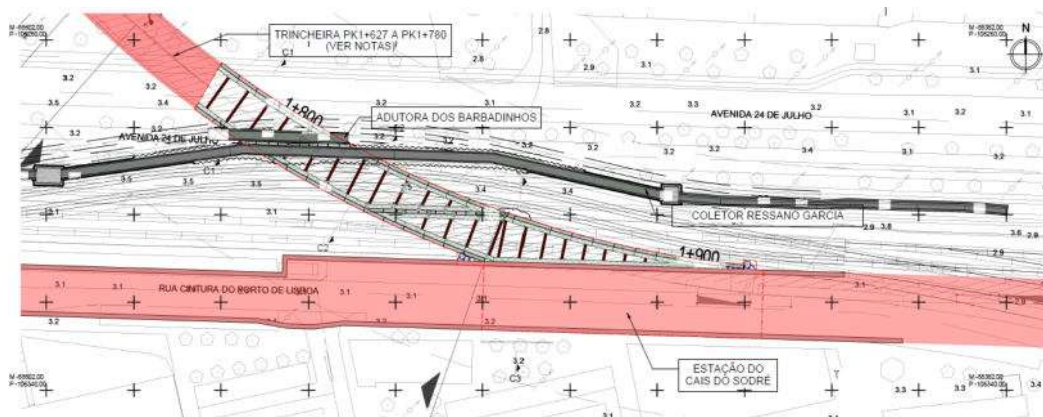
Contenção em Parede Moldada 800mm – Planta.
